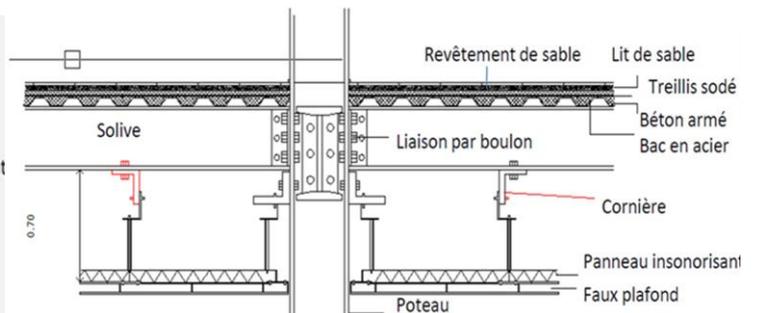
Coupe détaillée d'un assemblage boulonnage
